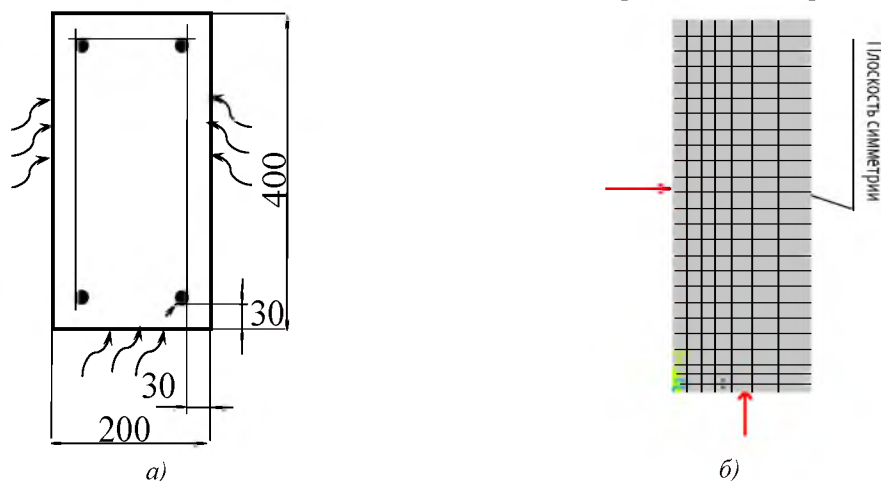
Расчетная (а) и конечно-элементная (б) схемы сечения железобетонной балки.
